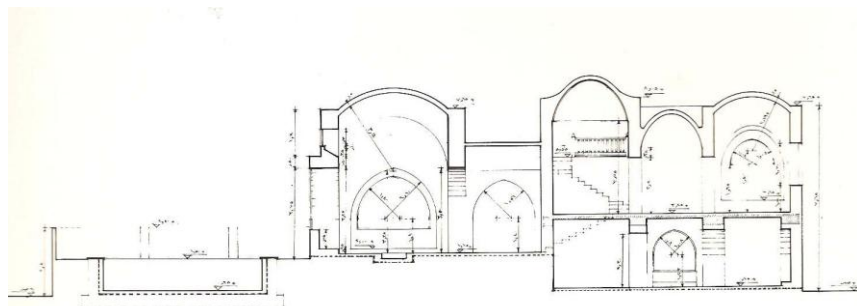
Secciones longitudinales y transversales. Greiss House
